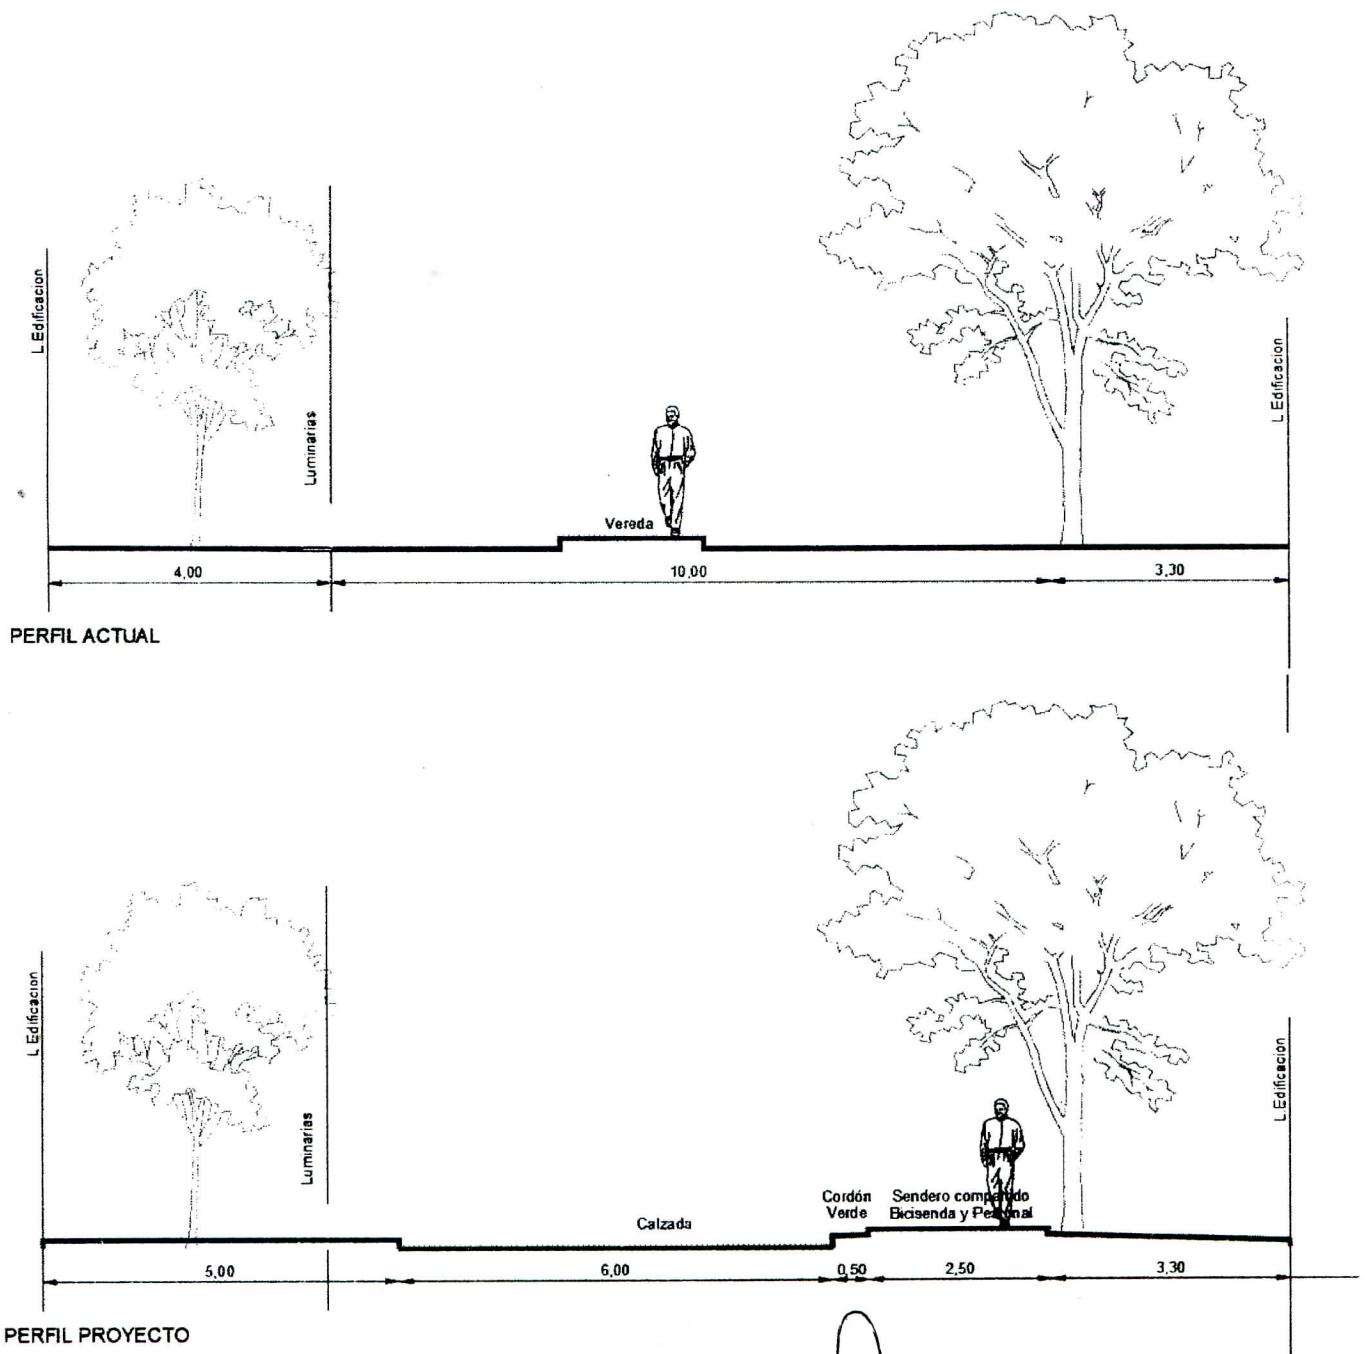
Situación actual y proyecto. Fuente: Elaboración propia
